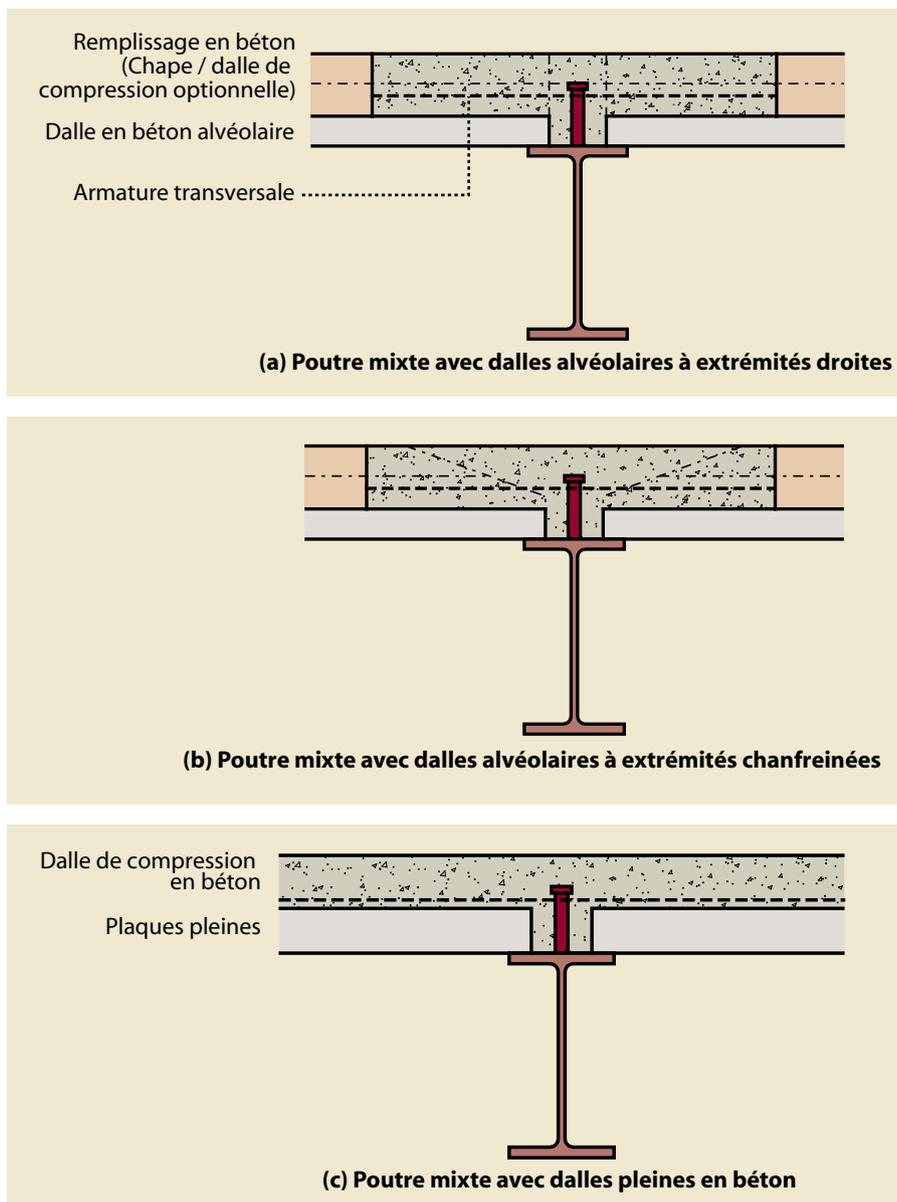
Formes de poutres mixtes utilisées avec des éléments préfabriqués
